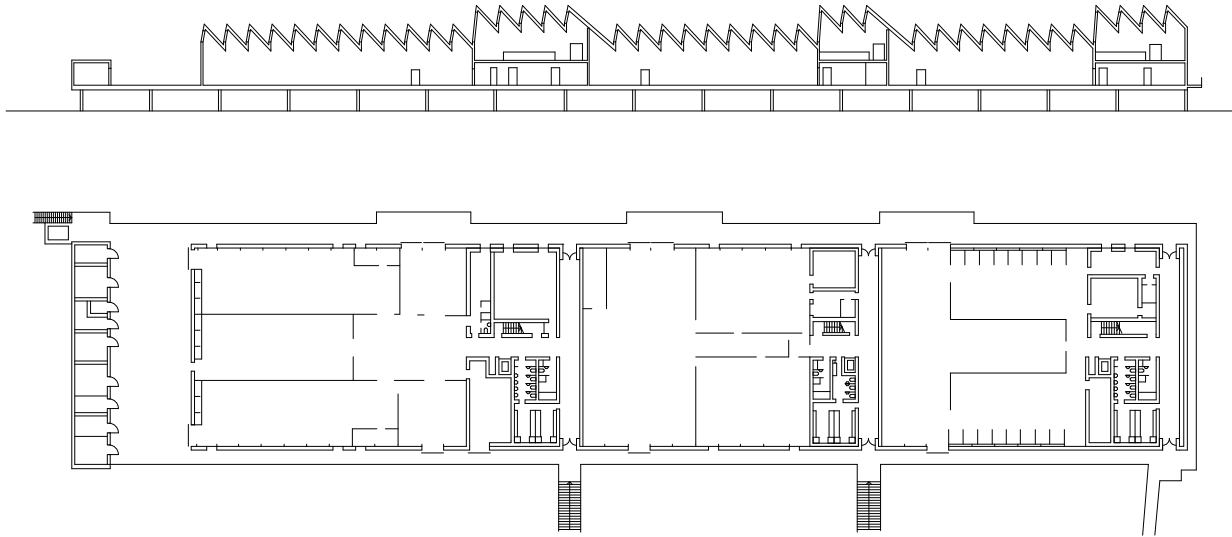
Schnitt und Grundriss M 1:1000
